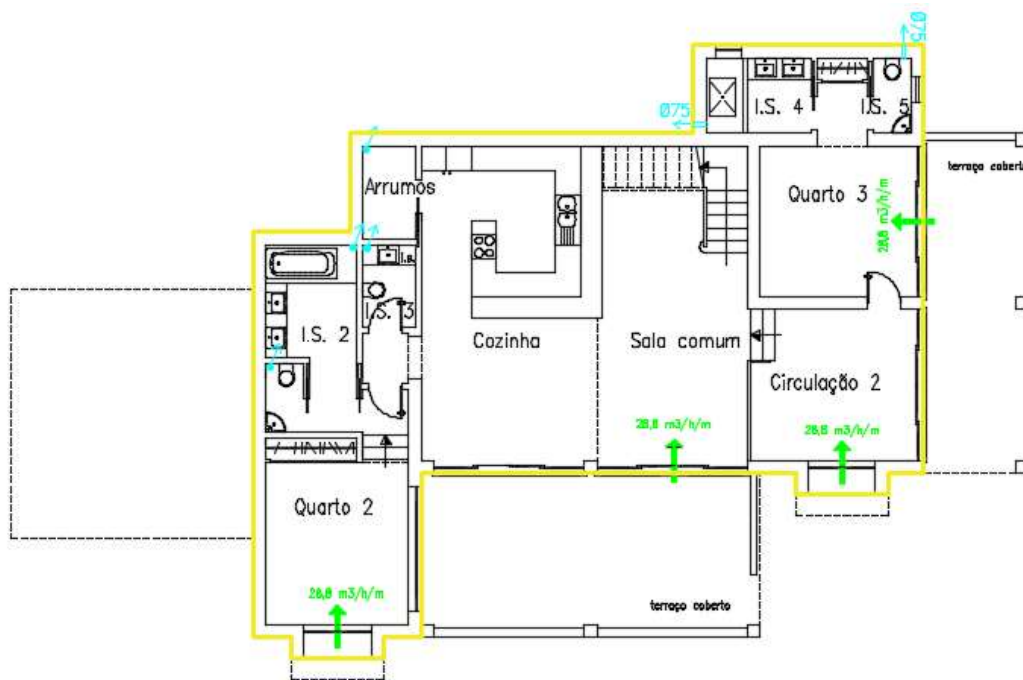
Projeto da ventilação natural na planta da semicave.
